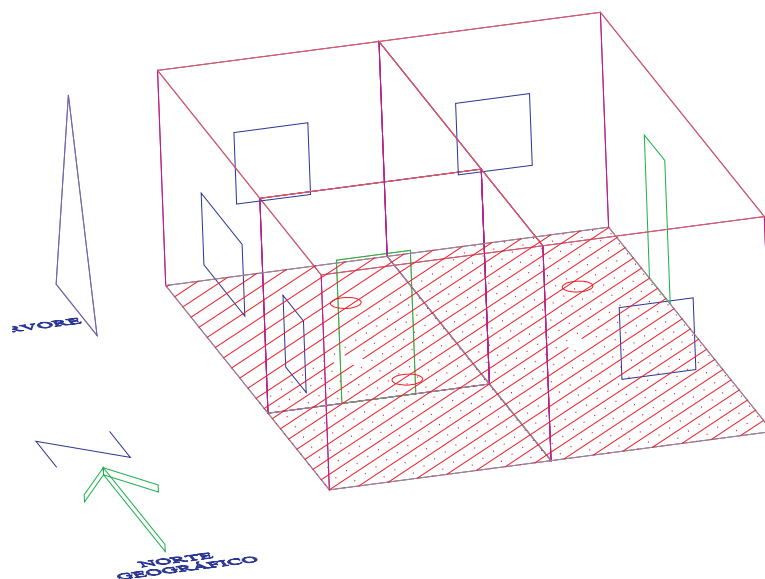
Casa Original com Árvore – Estudo de Caso 2 – Planta Baixa
